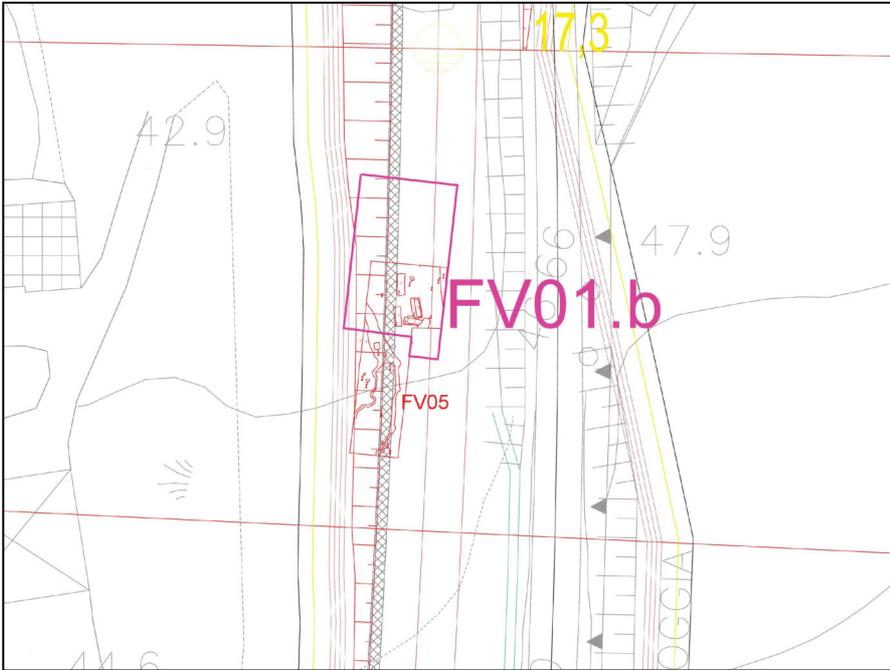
Stralcio planimetrico con l'area di estensione dello scavo di seconda fase di FV01b
